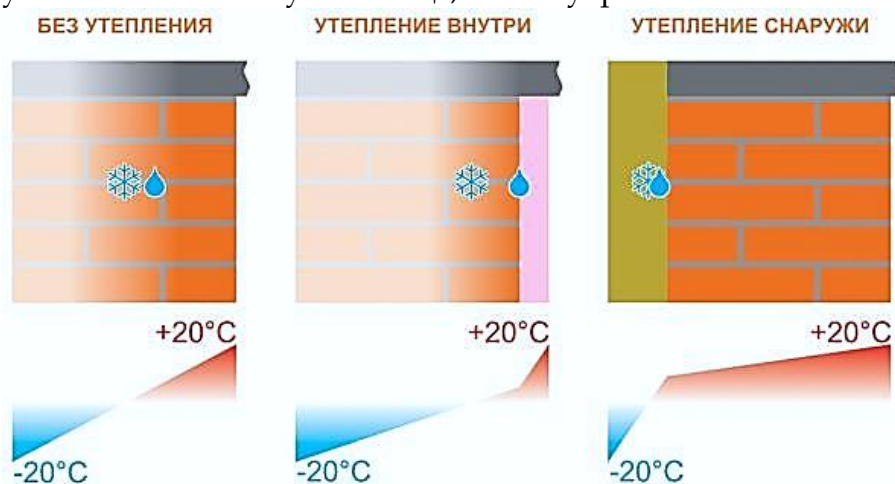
Точка росы для стены без утепления, с внутренним утеплением, с наружным утеплением [8]
